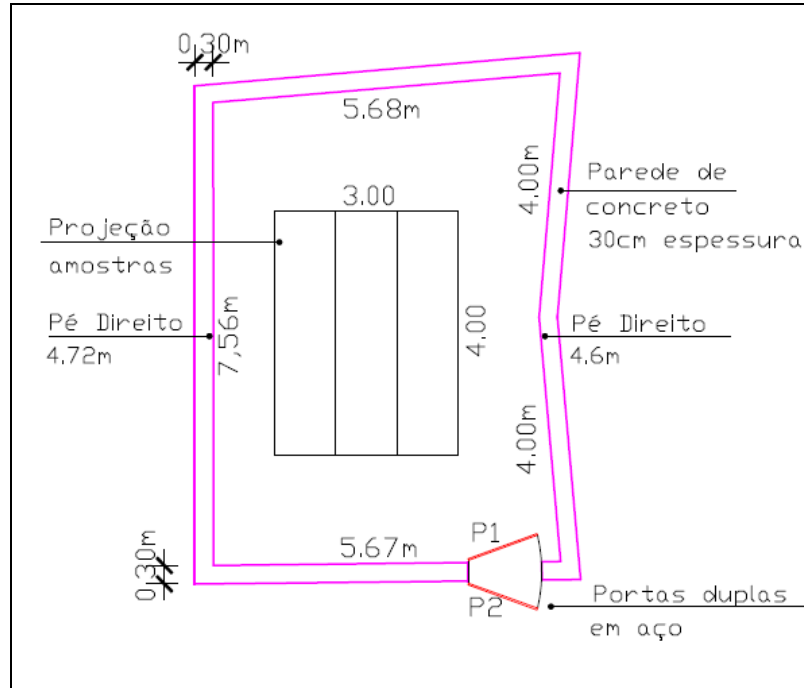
Esquema Planta Baixa Câmara Reverberante UFSM
